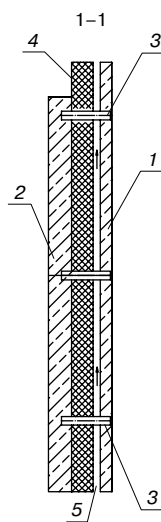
Сечение панели: 1 – внутренний слой; 2 – элементы наружного слоя; 3 – консольная связь; 4 – утеплитель; 5 – вентиляционный зазор
